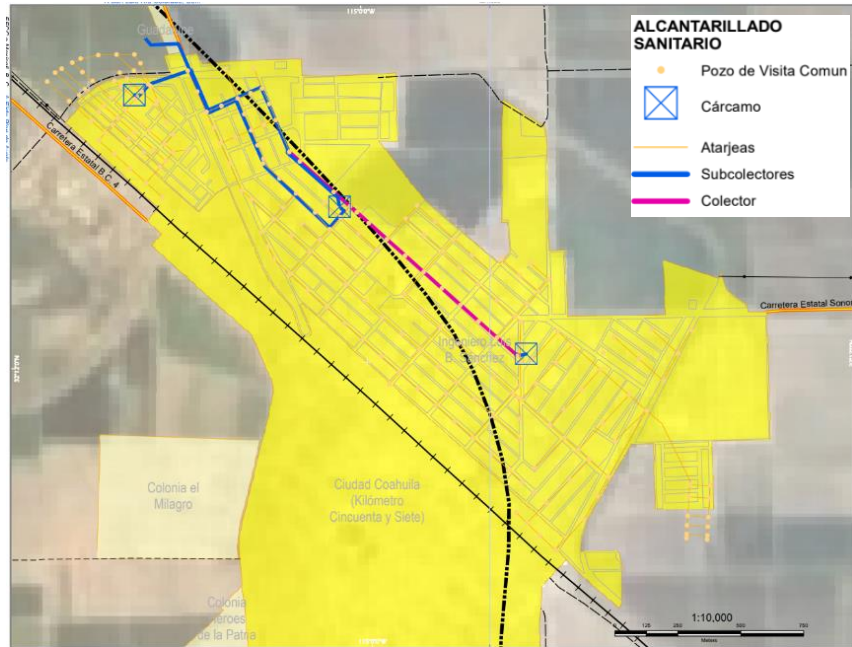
ALCANTARILLADO SANITARIO CENTRO DE POBLACIÓN DE ING. LUIS B. SÁNCHEZ
